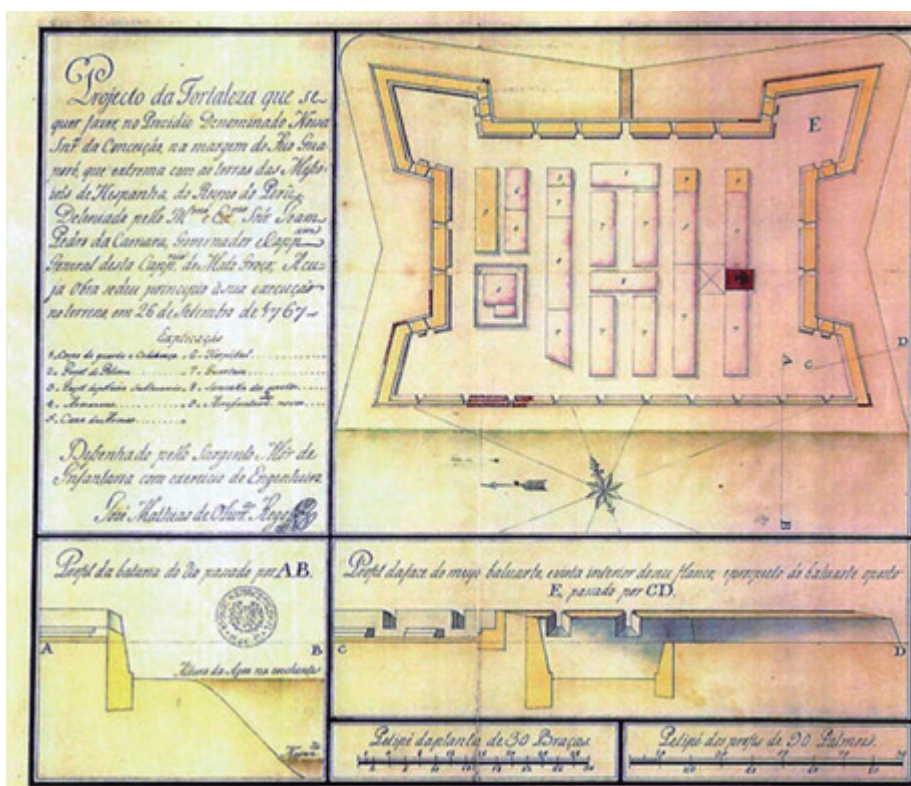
Projeto do Forte de Bragança (antigo Forte de Nossa Senhora da Conceição)
